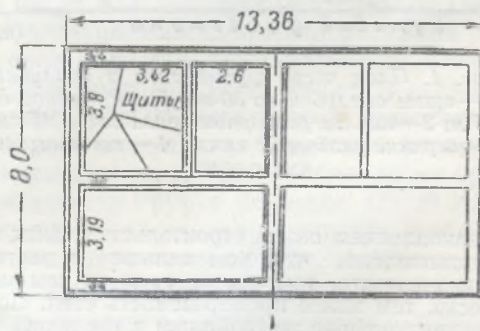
План двухквартирного дома с размещением опалубочных щитов.
